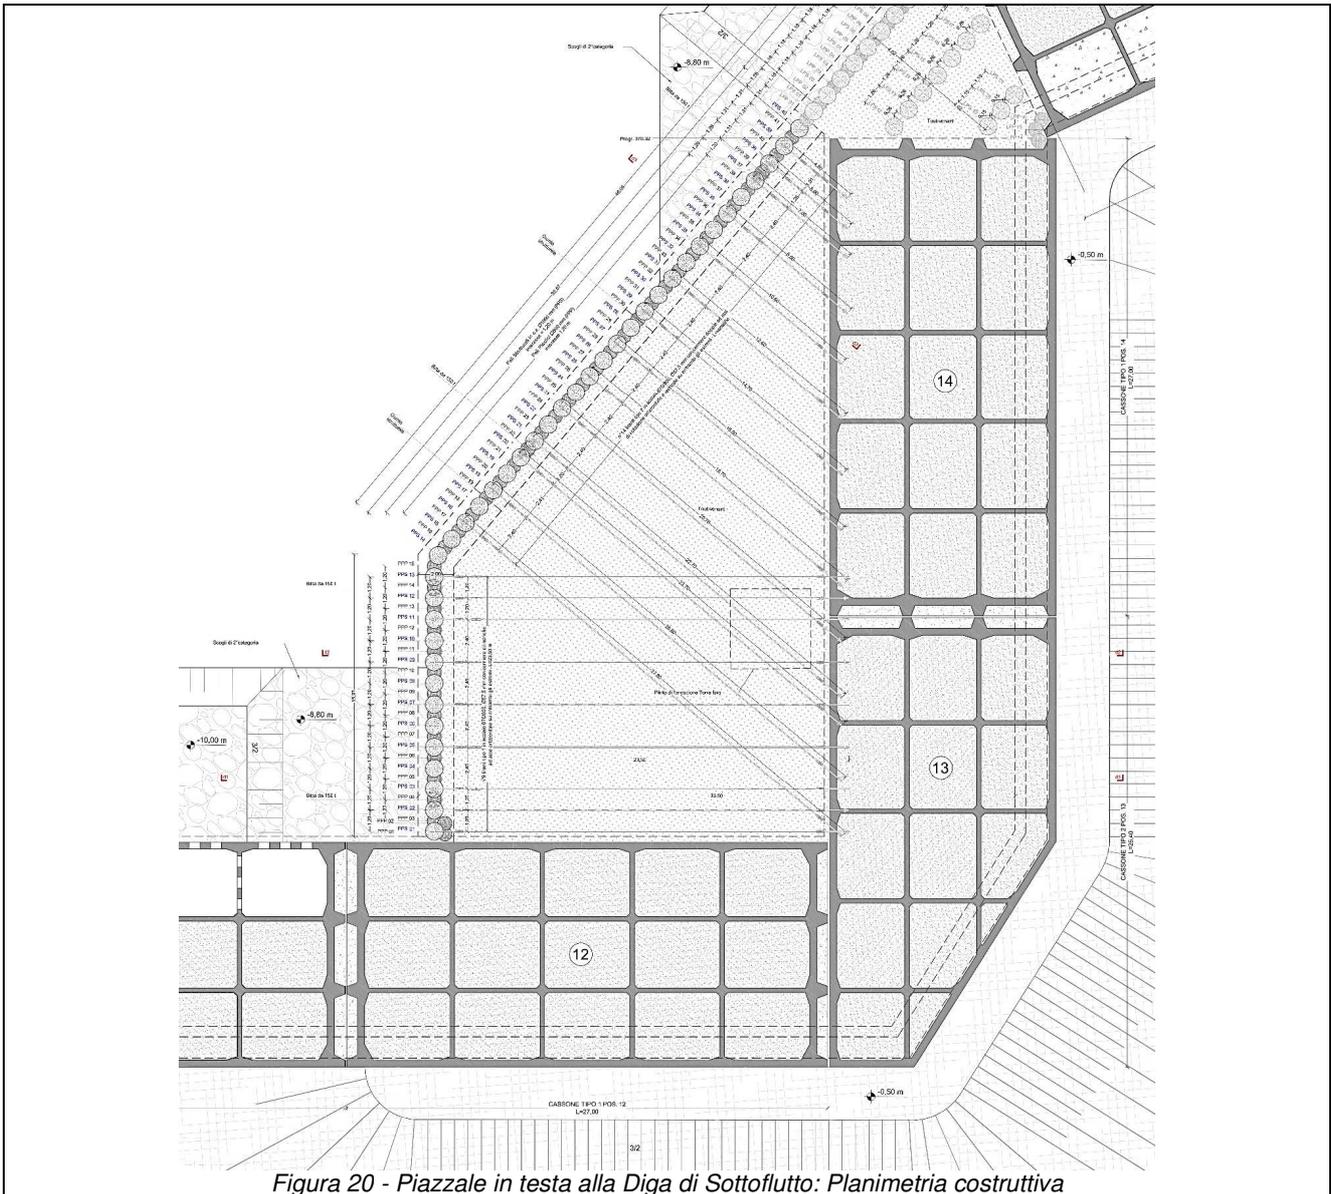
Piazzale in testa alla Diga di Sottoflutto: Planimetria costruttiva
